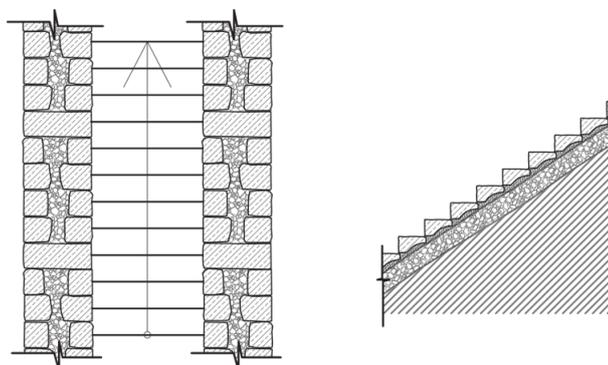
Untermauerte Natursteintreppe– Grundriss & Schnitt
